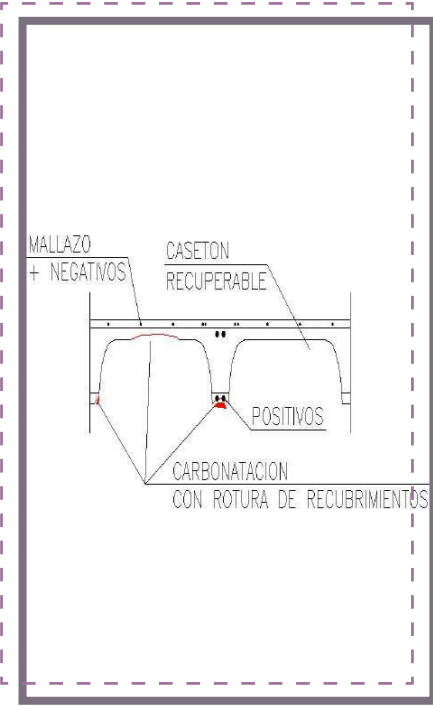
Esquema de depósitos en forjados de hormigón armado.
